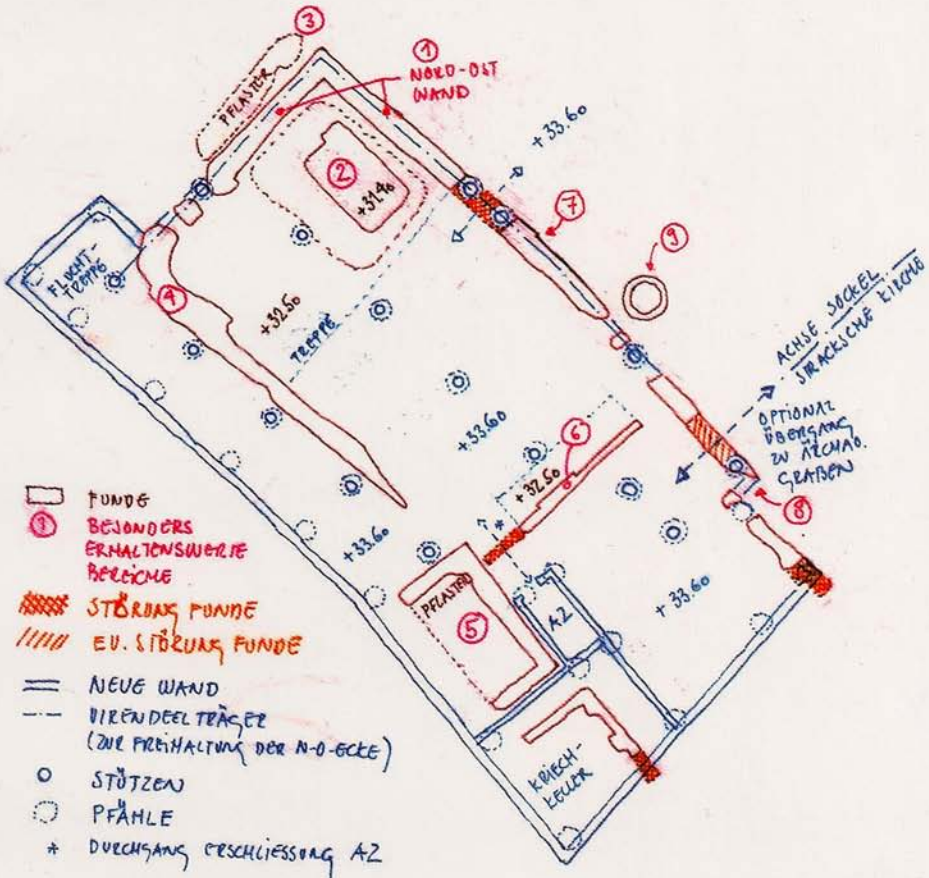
Workshopergebnis Sicherung der Funde, Grundriss Stand März 2008 (Jordi & Keller Architekten).
